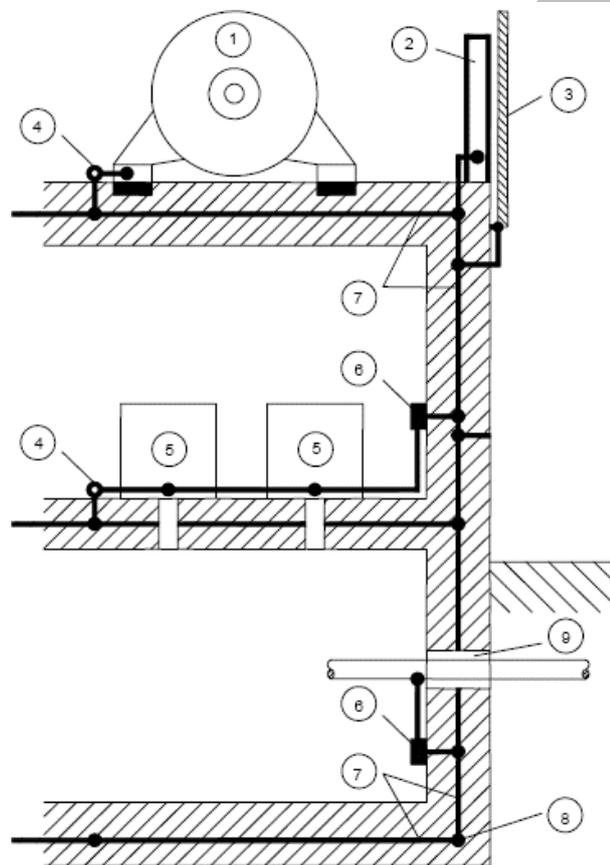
Unión equipotencial de una estructura con refuerzo de acero.
